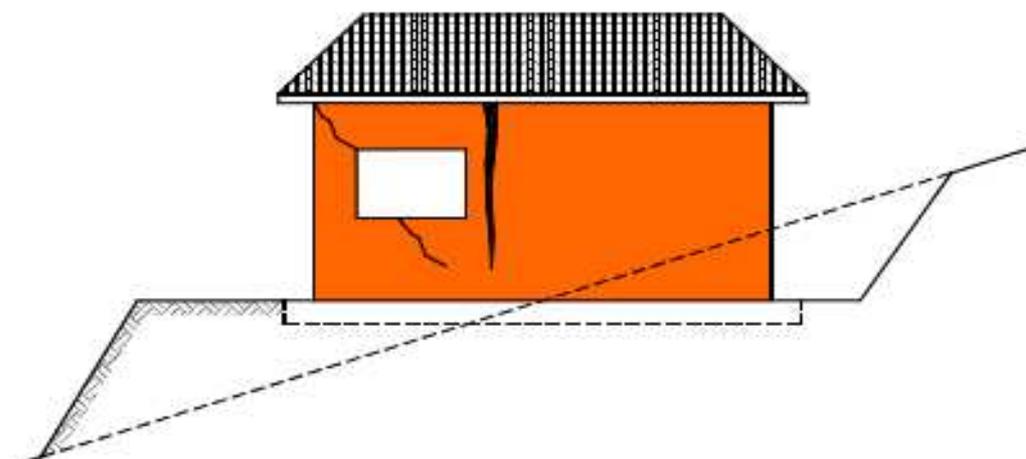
Fundações assentadas sobre seções de corte e aterro; fissuras de corte nas alvenarias (Fonte: THOMAZ, 1989).
